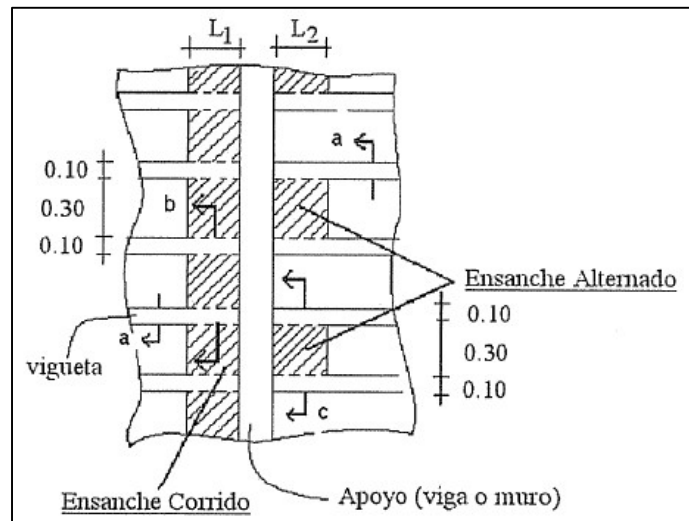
Esquema de ensanches en losas aligeradas (Ottazzi, 2016).
